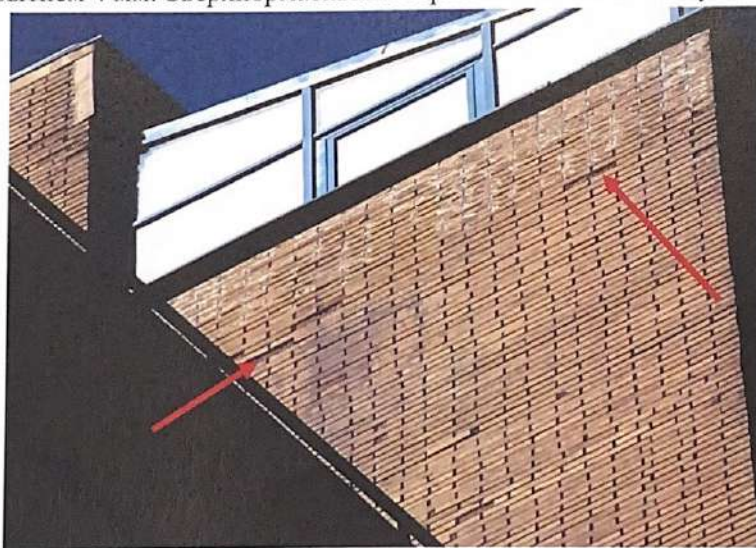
/141. Секция 11. Фасад 2. Поперечная стена. Поверхностные разрушения подпарапетной зоны.
